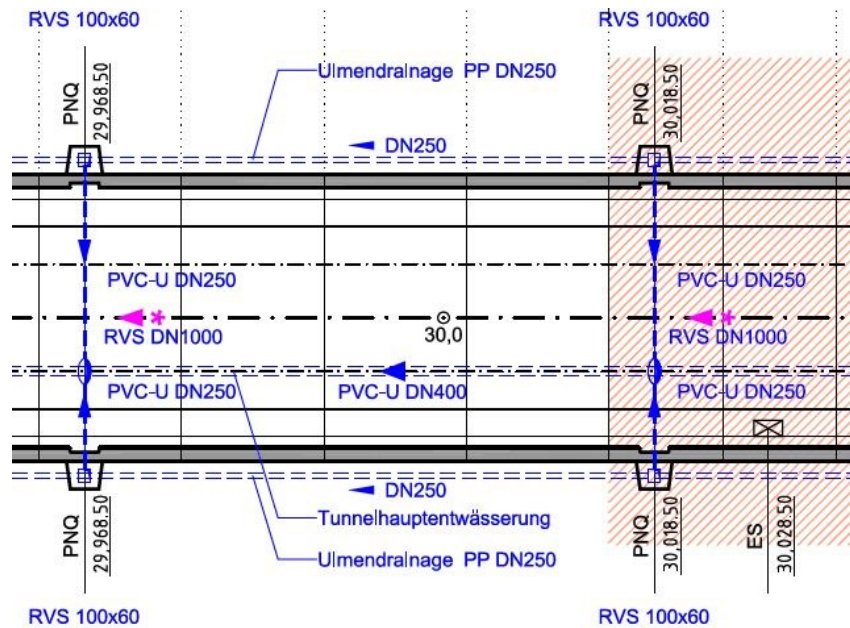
H2-1 Haupttunnel Anhydritbereich – drainiert [37]
